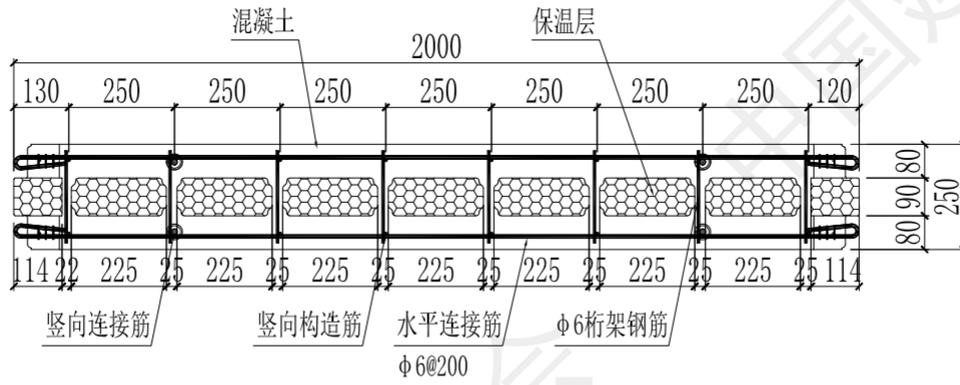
(b) 有肋自保温结构墙体横截面二维平面图
